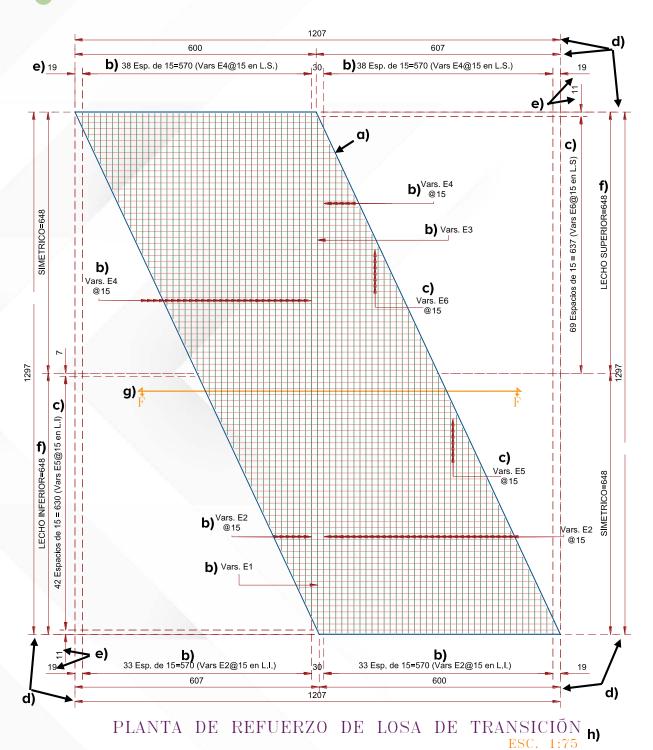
Ejemplo de planta de refuerzo de la losa de transición
